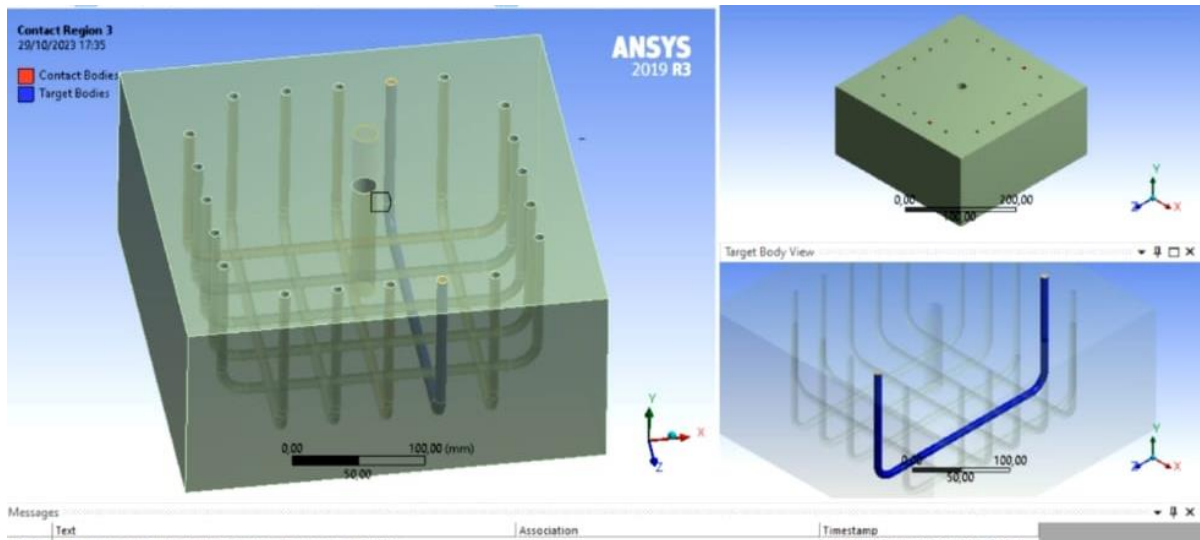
Conexión tipo soldada entre varilla de 5 mm y concreto
